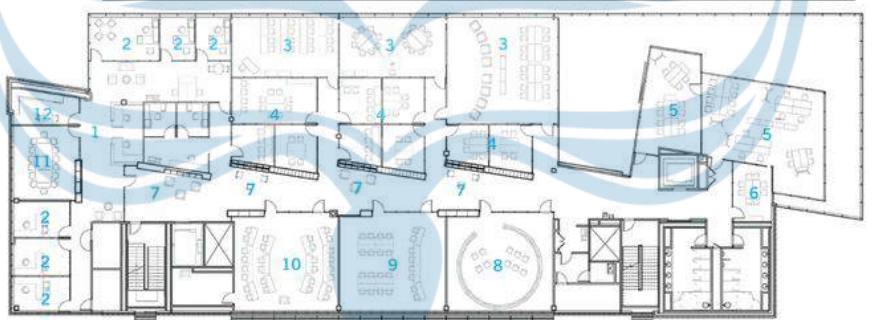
Siteplan dan denah lantai-1 Watt Family Innovation Center
